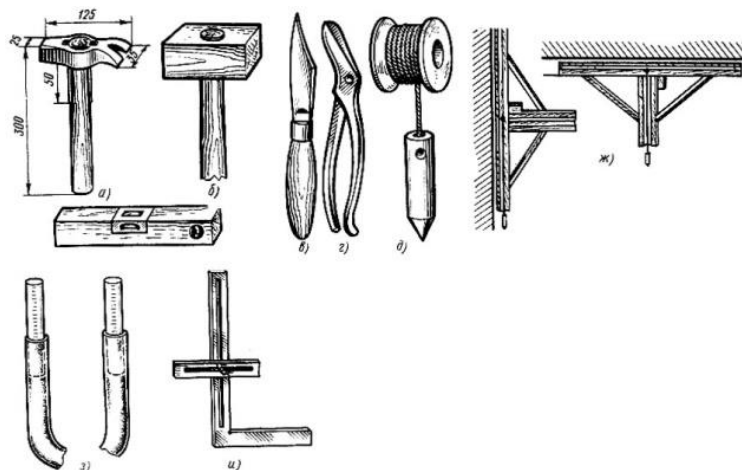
Инструменты для подготовки и проверки поверхностей: а - штукатурный молоток, б - кулачок, в - штукатурный нож, г - ножницы для резки металла, д - отвес, е - уровень, ж - ватерпас, з - водяной уровень, и - угольник с передвижной планкой
